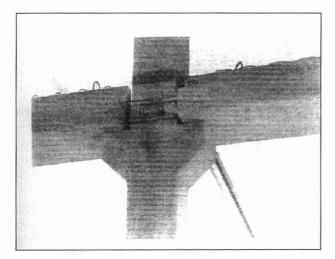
Nudo "pilar prefabricado-viga prefabricada" en ejecución.
